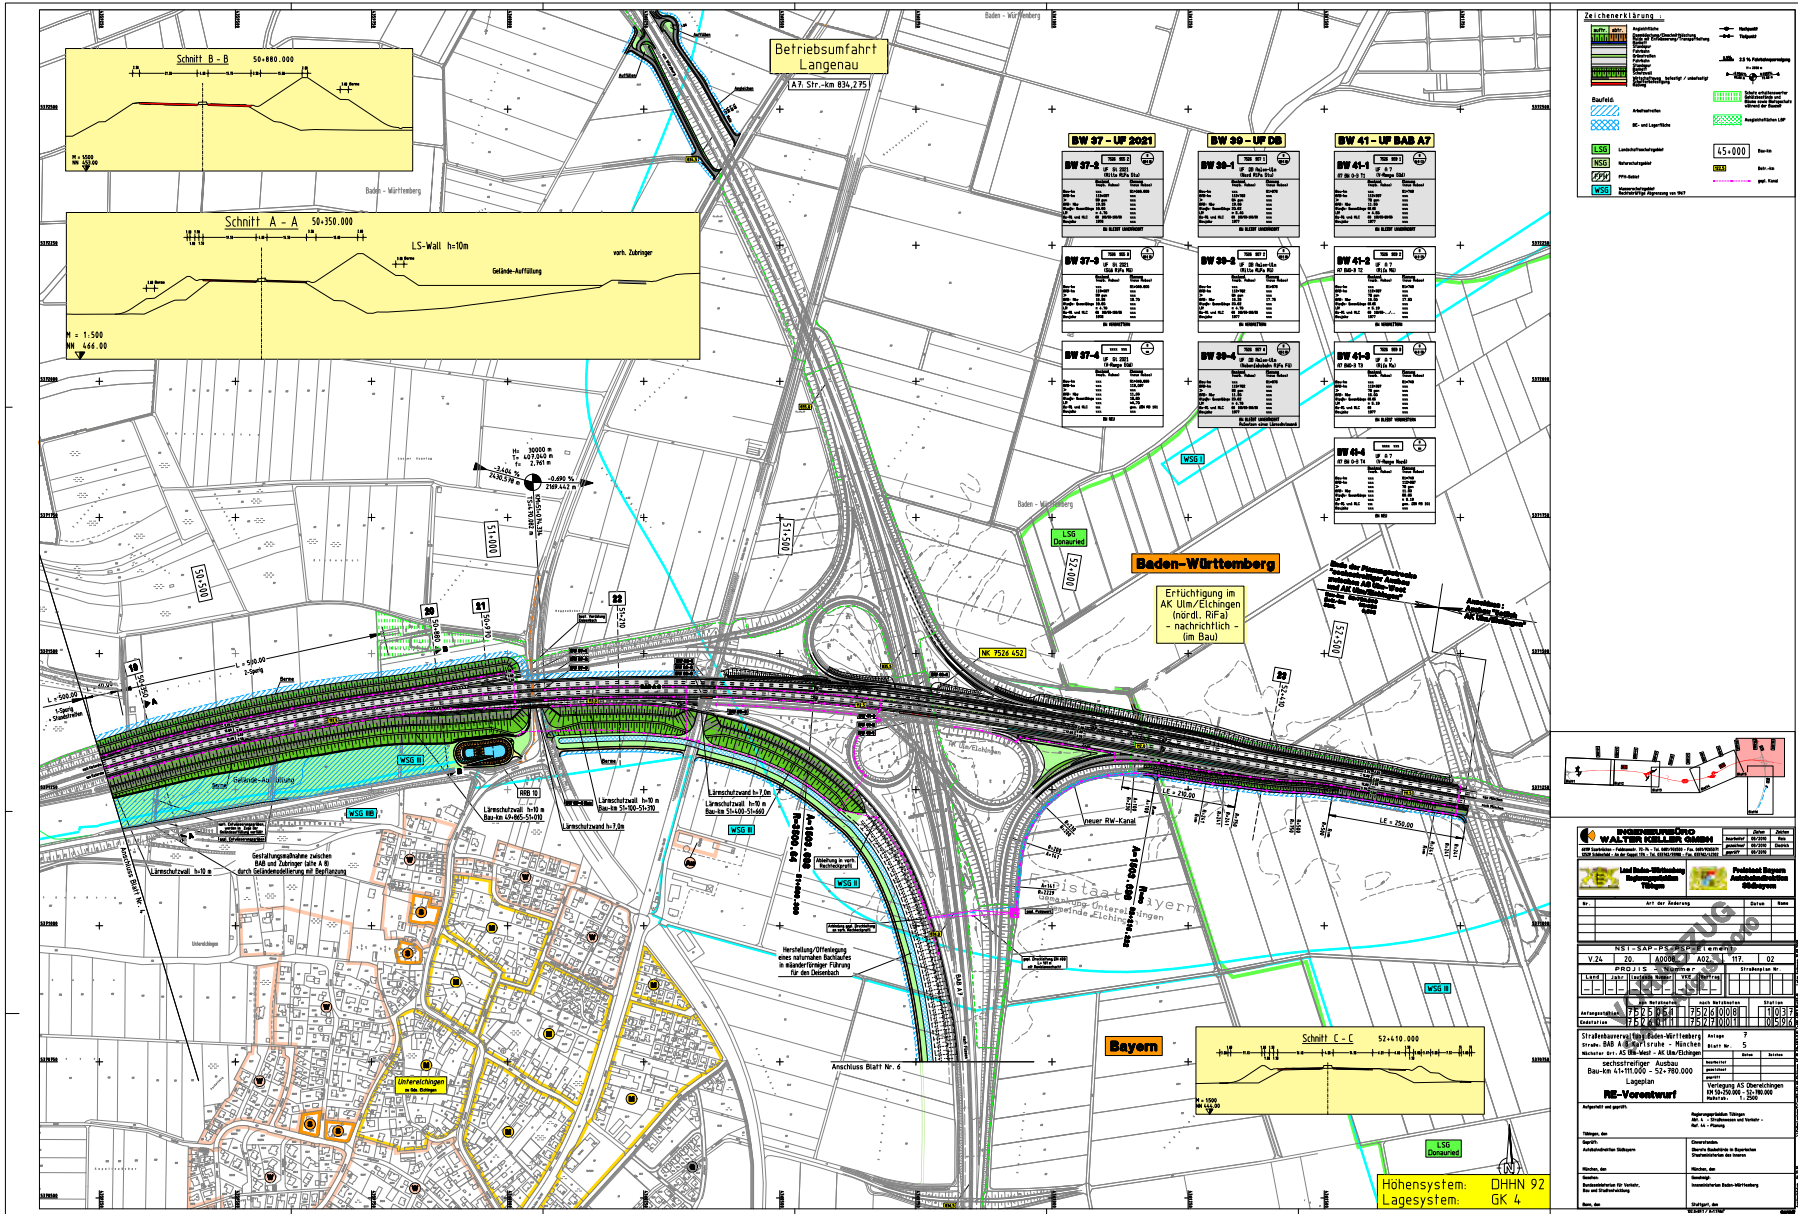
Lageplan - Ertüchtigung des bestehenden Anschlusses Oberelchingen 2
